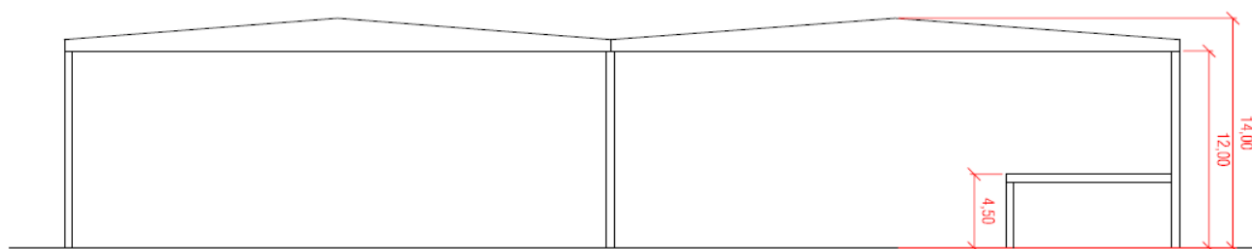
Plano sección escenario semiautomático Fuente Elaboración propia
